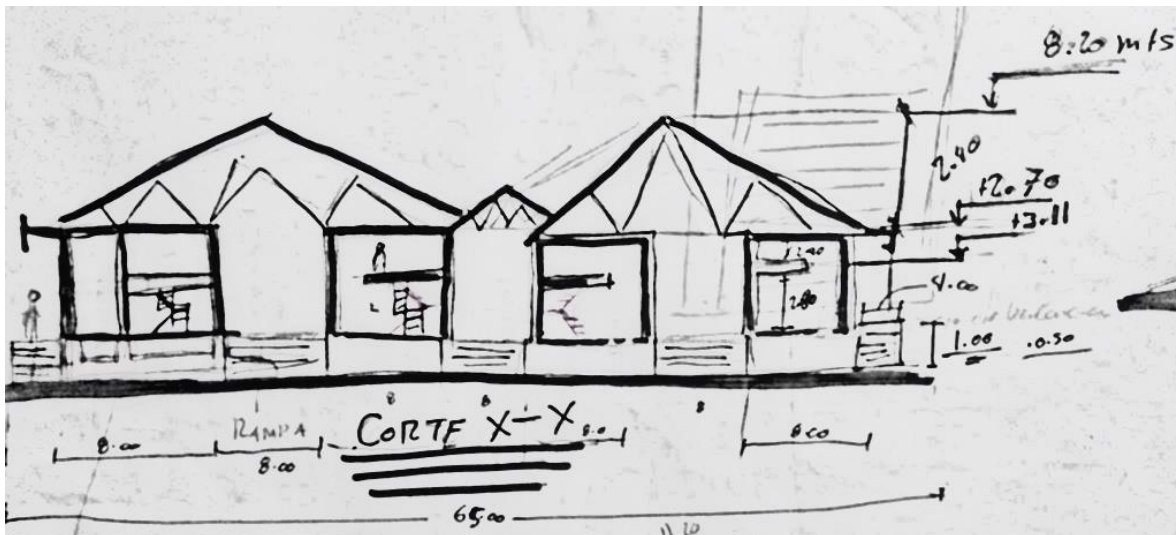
Foto corte de planta de conjunto, Fuente: elaboración propia.
